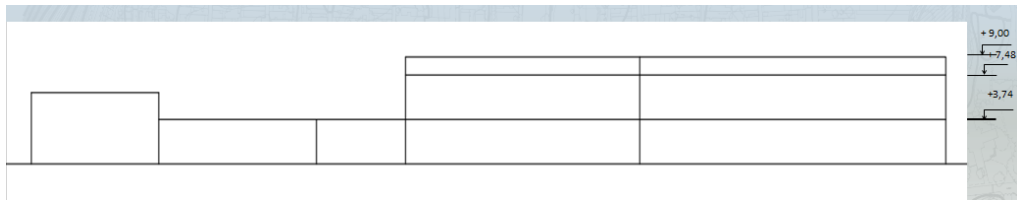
Perfil Calle Comercio fuente: La autora (2022)
